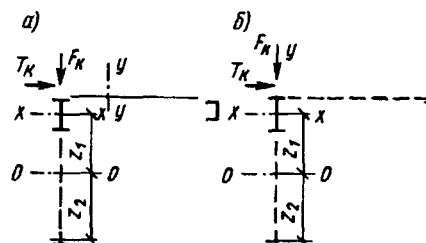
К расчету подкрановых ферм с тормозной балкой (а) и с тормозной фермой (б)
